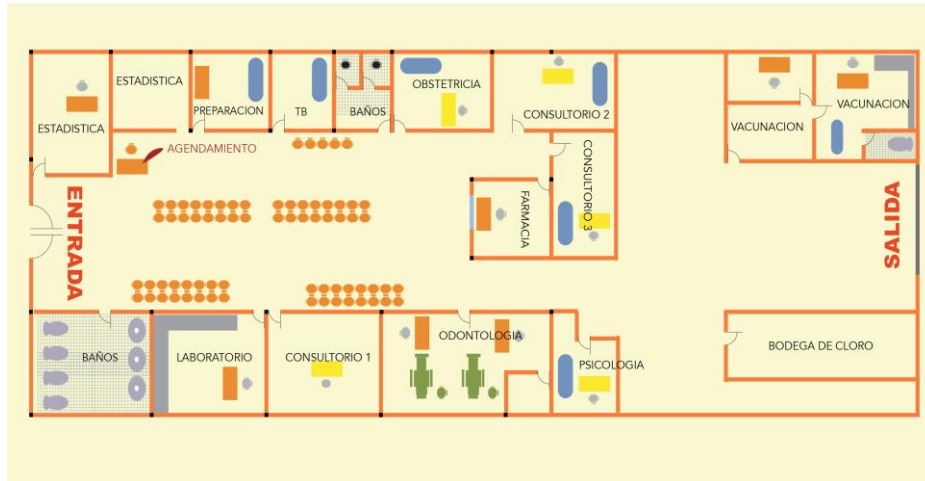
Plano Instalaciones Centro de Salud Venezuela
